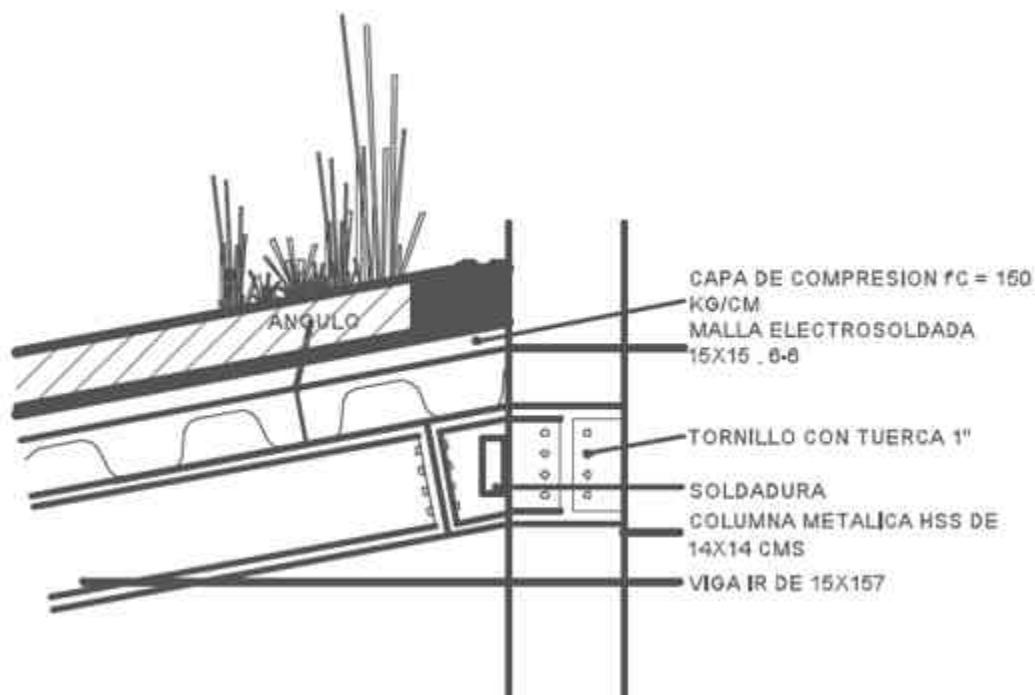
Detalle de viga para recibir la losacero y el sustrato para techo verde.
